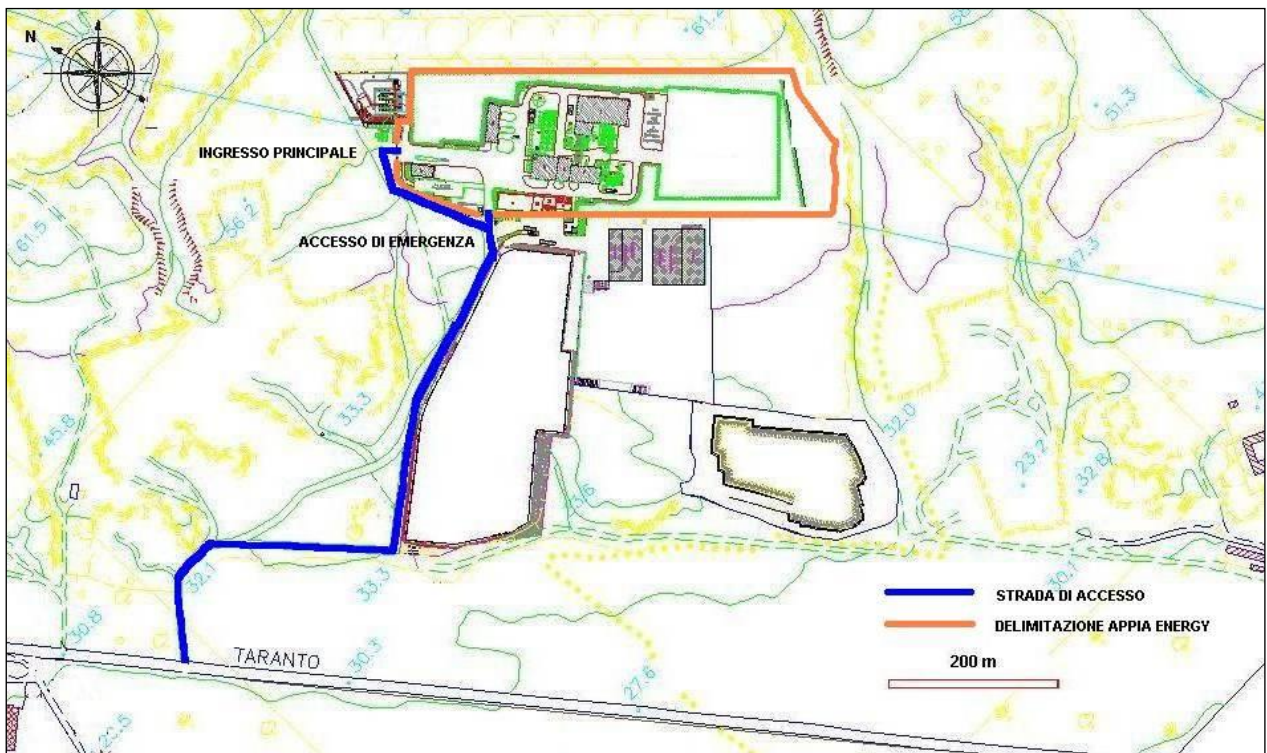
c: Planimetria generale con viabilità esterna
